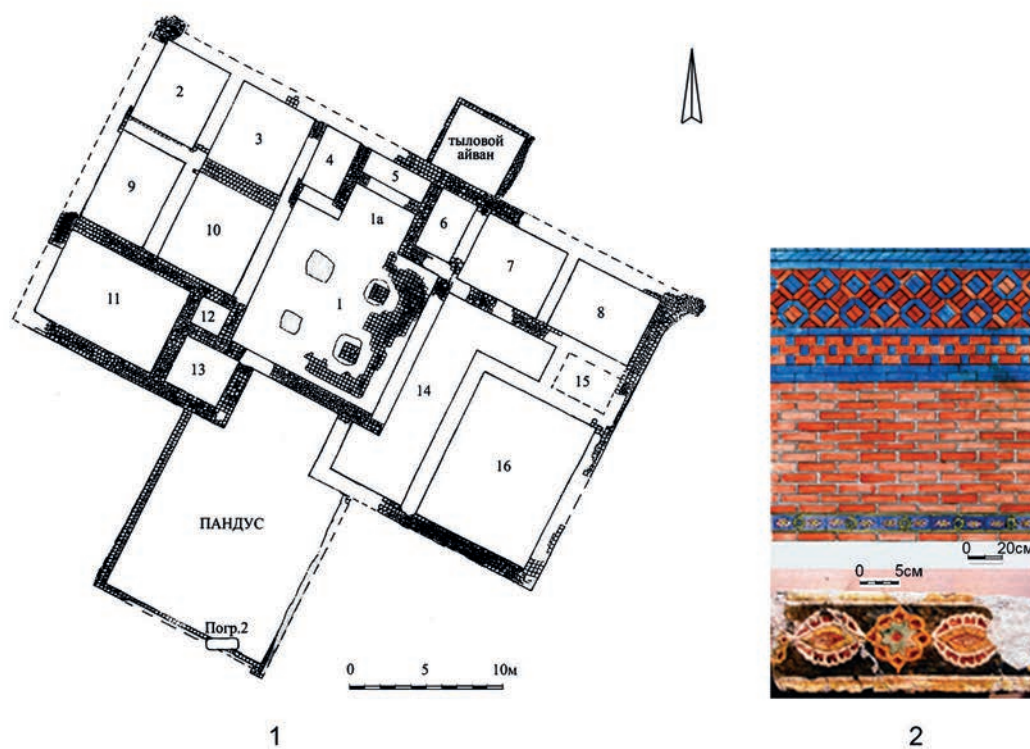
Усадьба Ag1: 1 – общий план; 2 – фриз на стене здания (по В.В. Плахову).
